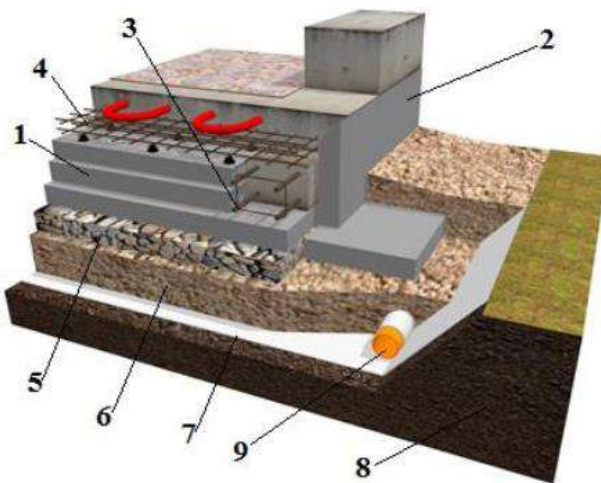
Фундамент мілкового закладання типу «Шведська плита»: 1 - PIR -плита; 2 - бетона конструкція фундаменту; 3 - арматура; 4 - система водяного обігріву підлоги; 5 – щебенева підготовка; 6 – ґрунт зворотнього засипання; 7 - геотекстиль; 8 - ґрунт основи; 9 - дренажна система
